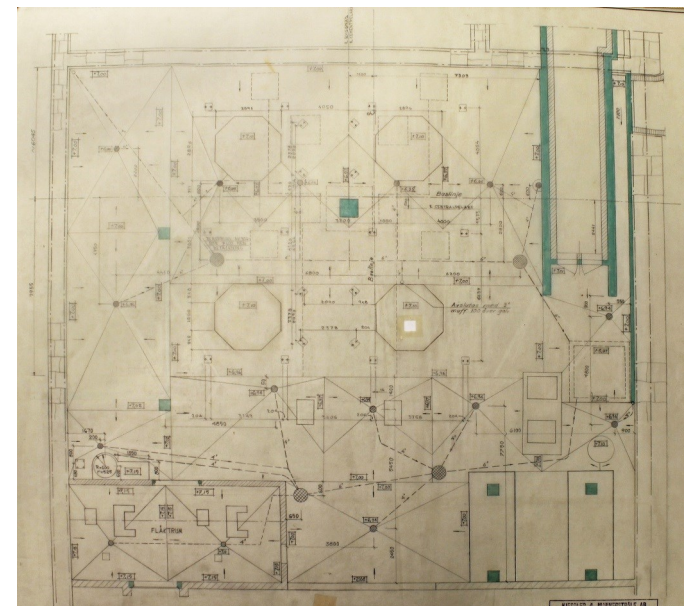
Planritning, oljegasverk, 1958. Källa: SSA
